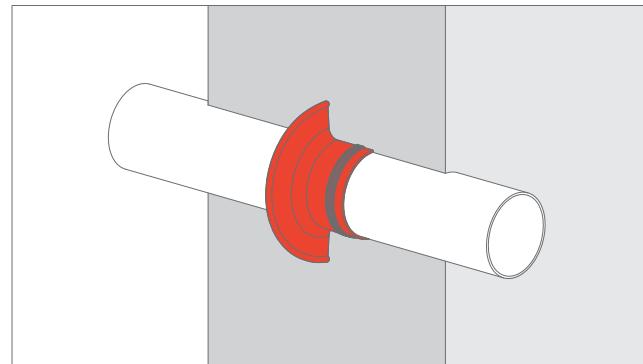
Encuentro de un muro con un elemento pasante horizontal mediante un elemento prefabricado embebido
